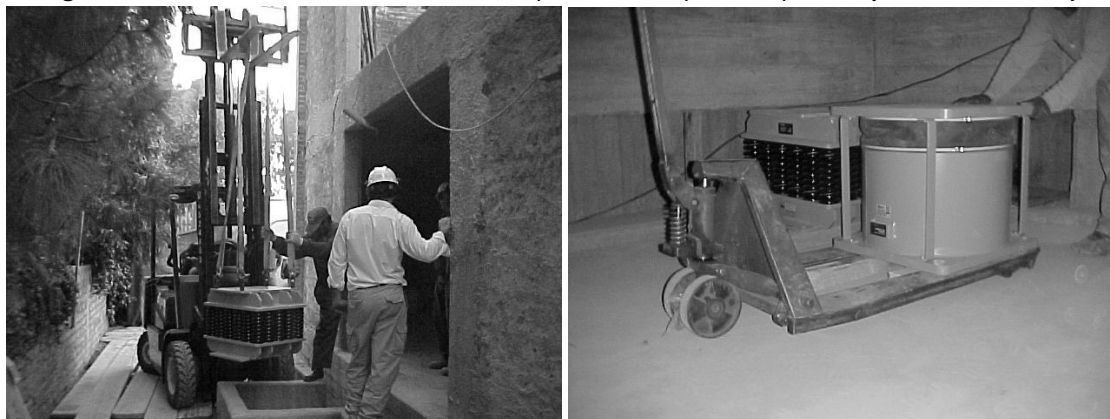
Edificio aislado en la etapa constructiva previa al montaje de los dispositivos de protección
